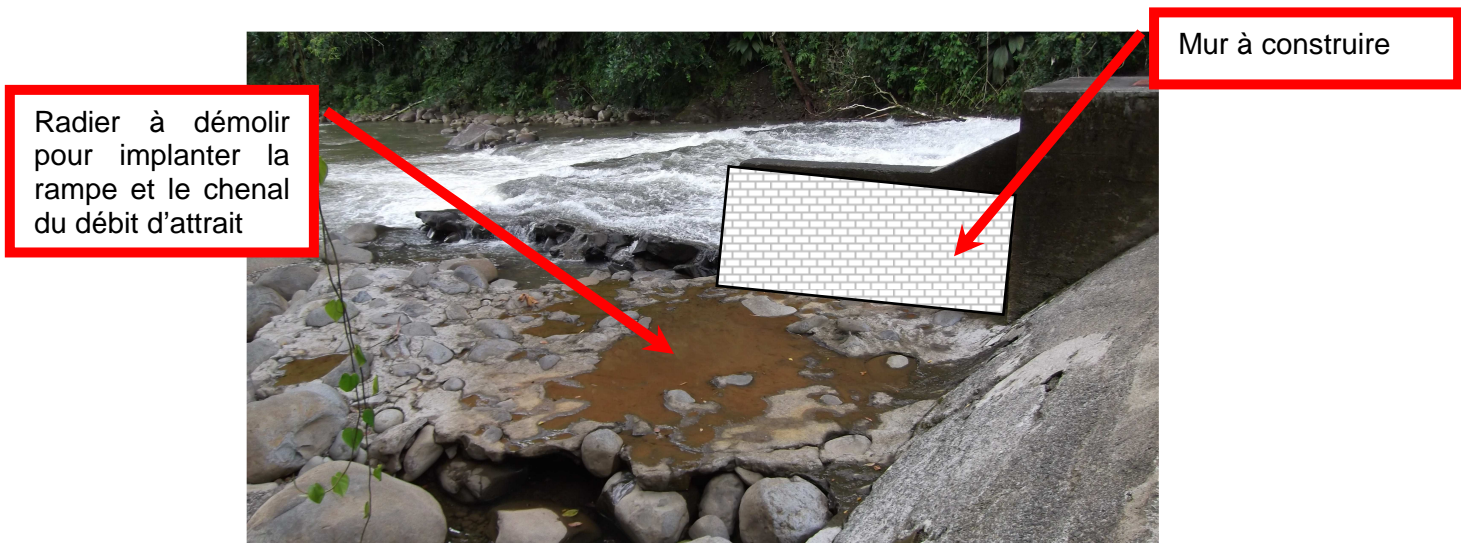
Radier à démolir en pied d'ouvrage et mur à construire pour isoler le vannage
